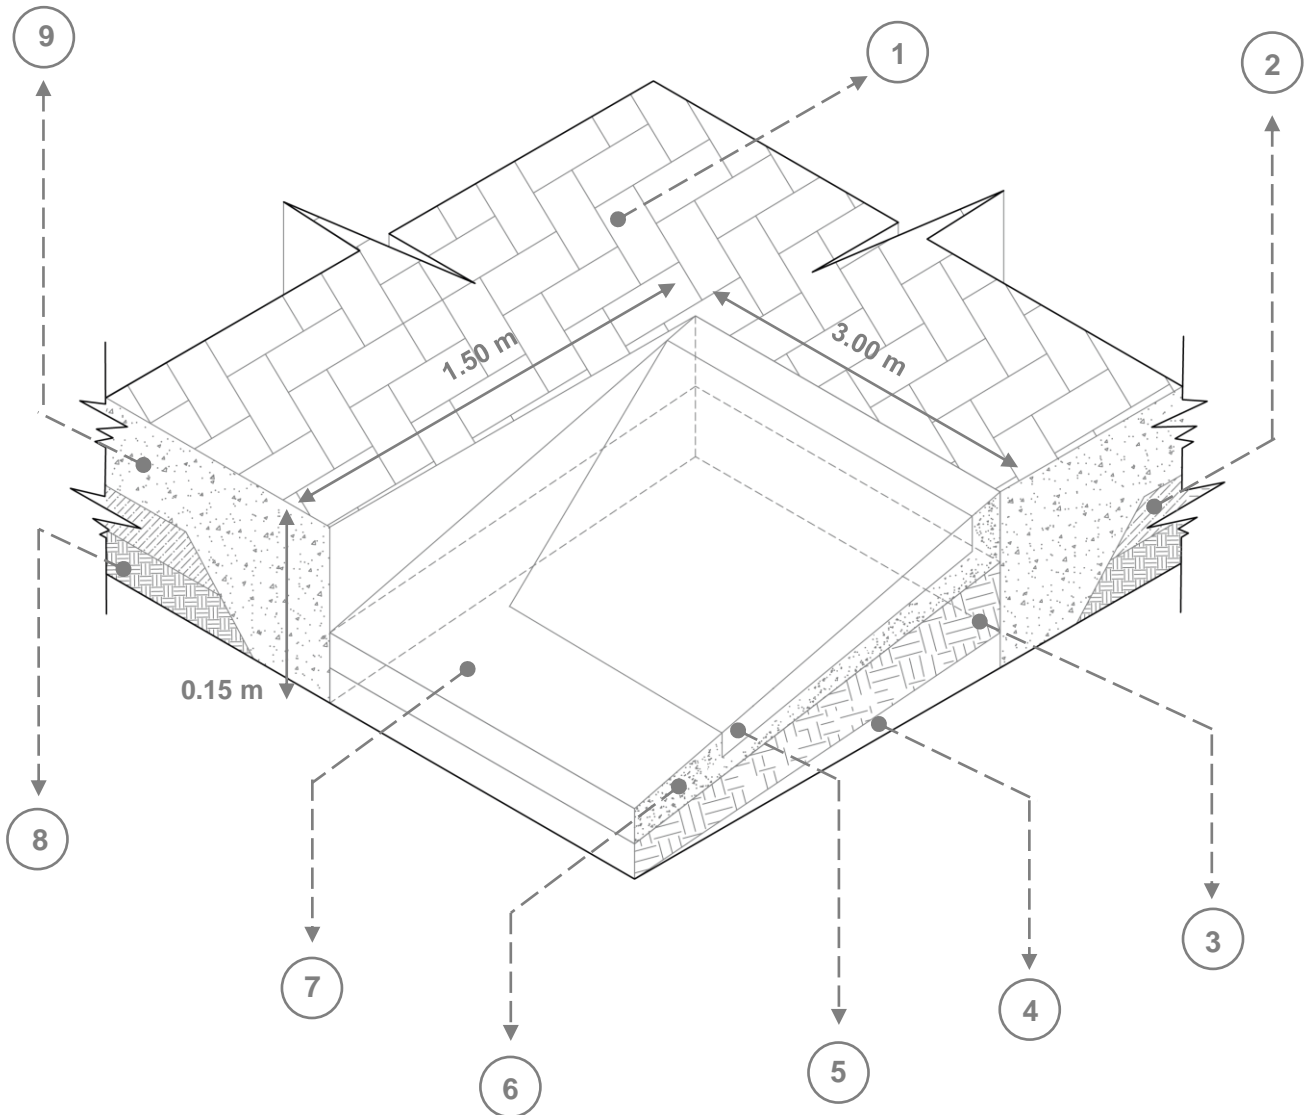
Detalle constructivo de rampa para personas con discapacidad
